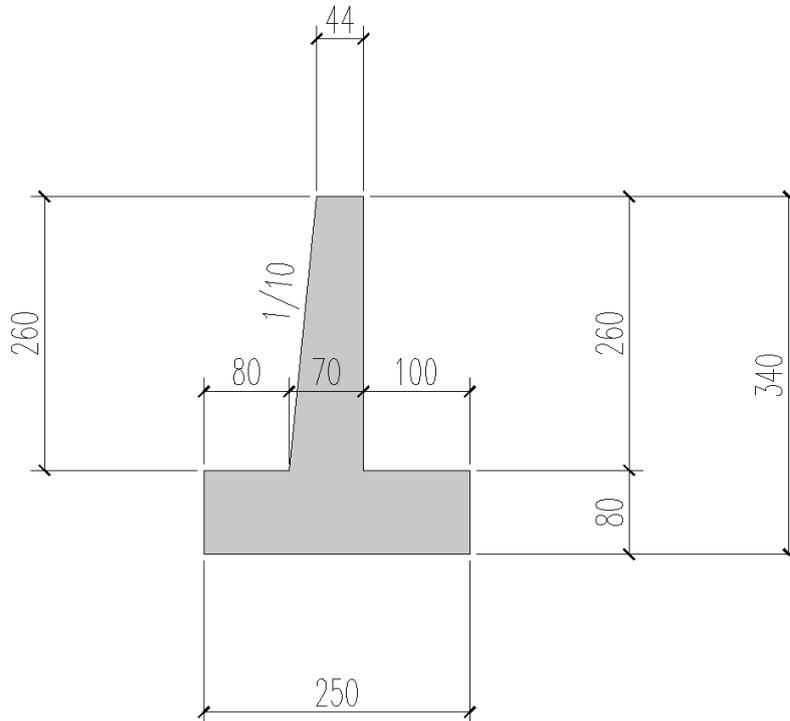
Carpenteria Sezione ad altezza maggiore del Muro M05
